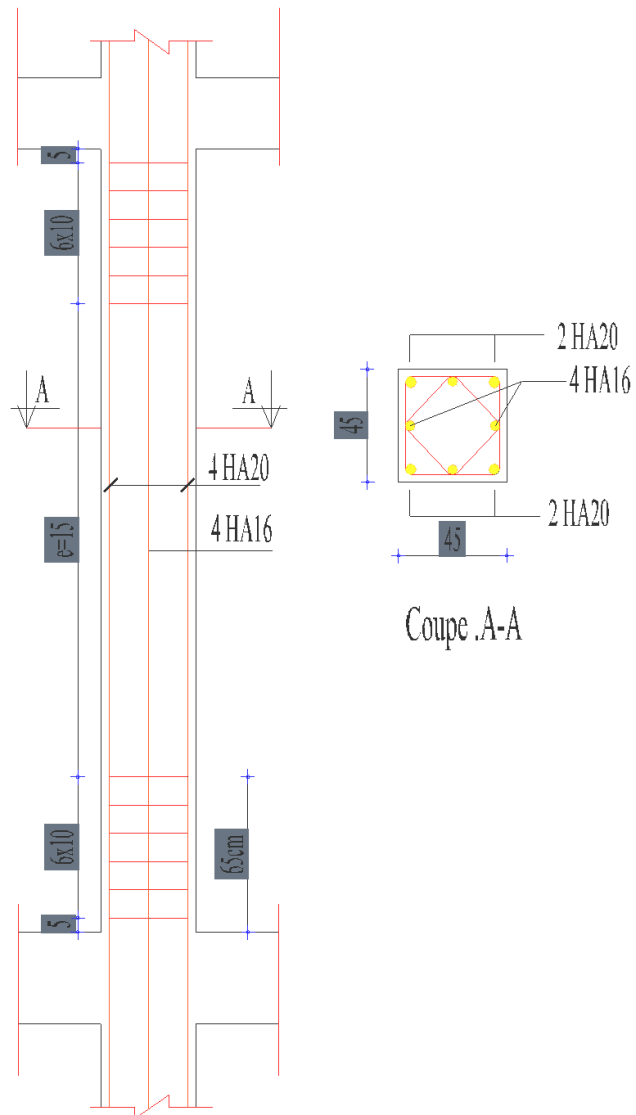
Schémas de ferrailage des poteaux (45 x 45)
